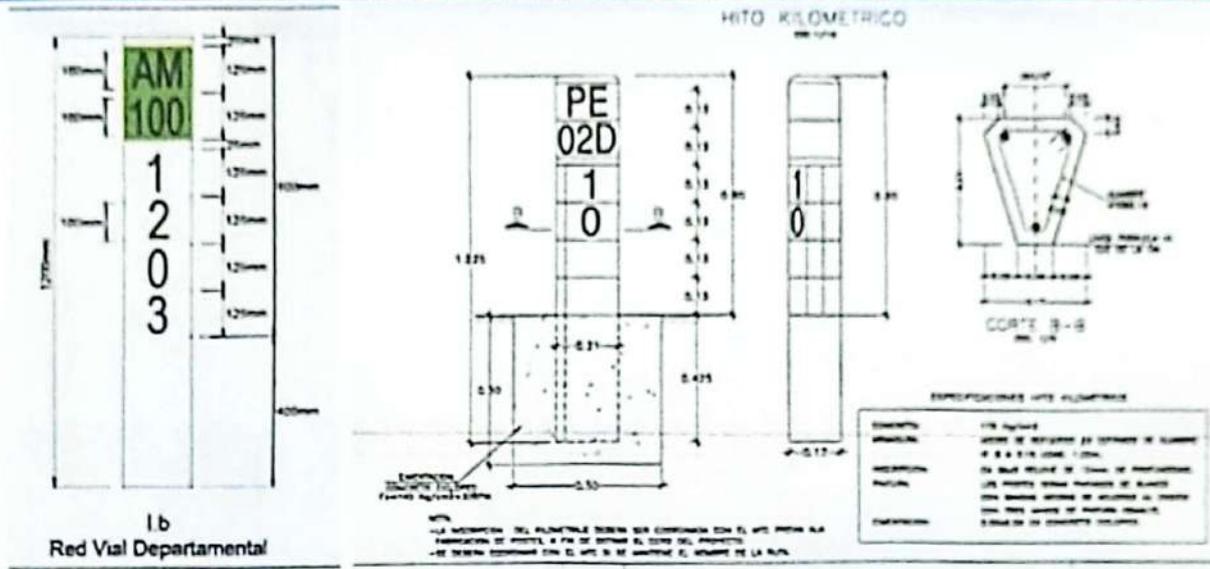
Se muestra el diseño y características técnicas del poste de kilometraje según el detalle constructivo incluido en el plano SÑ-85 del expediente técnico
